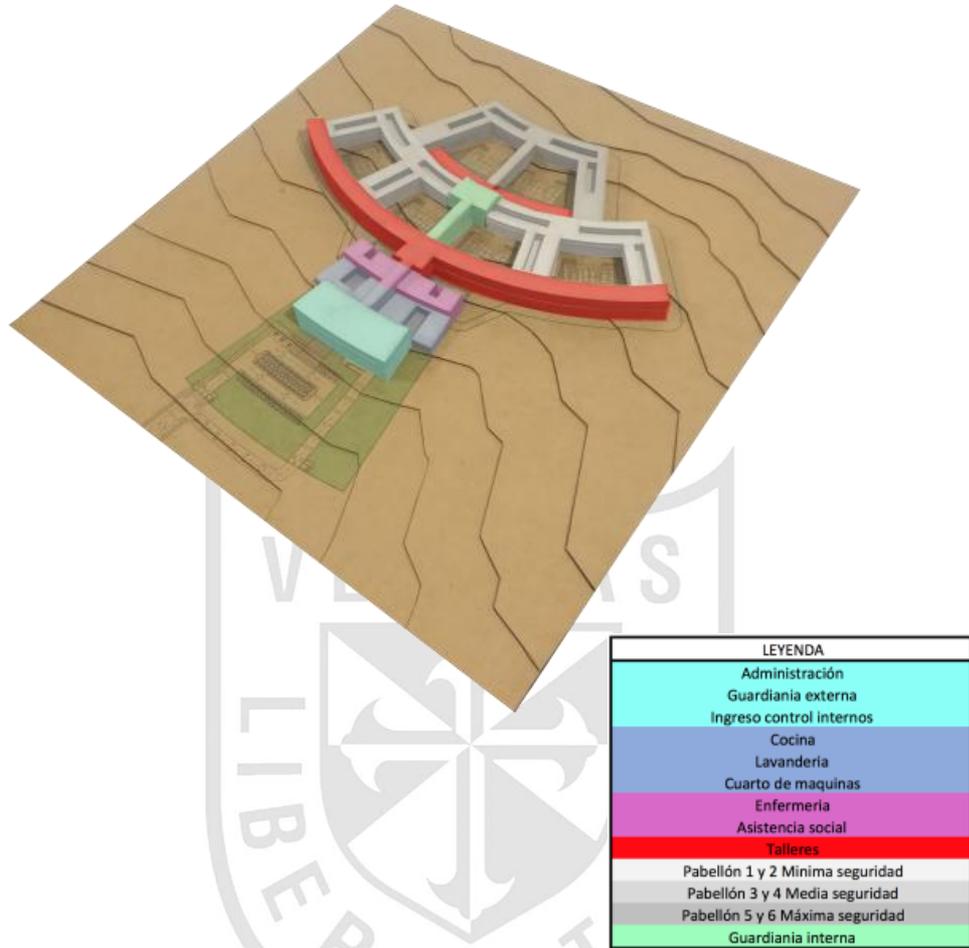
Vista tridimensional del proyecto Fuente: Propia
